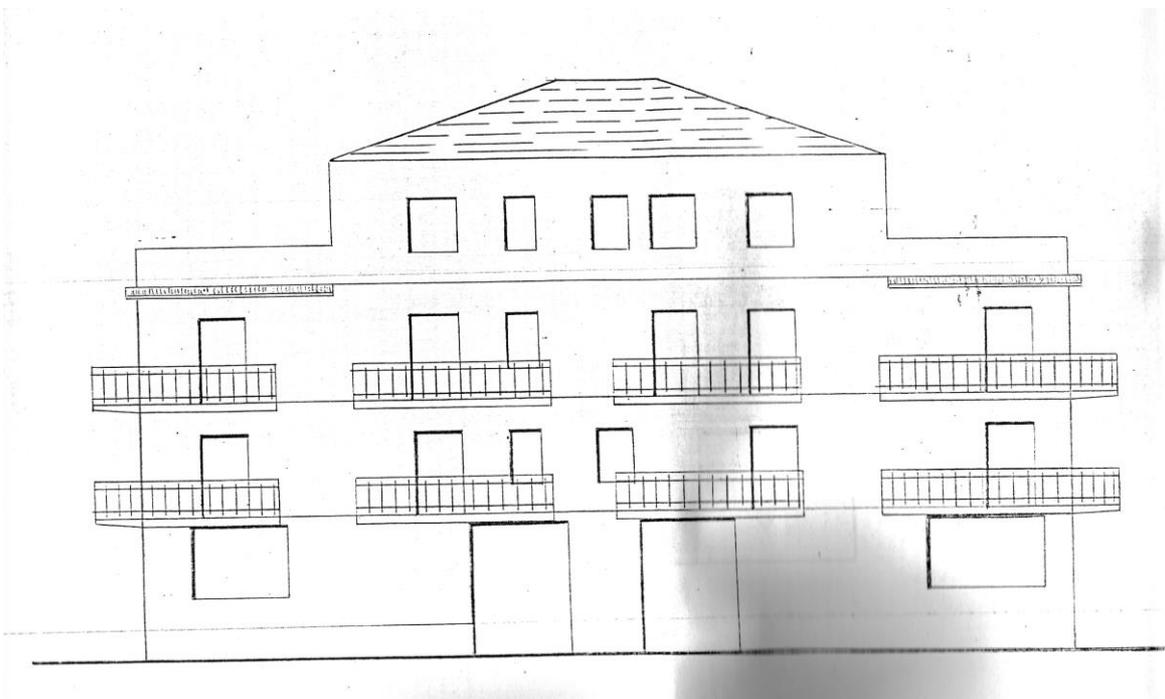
Confronto tra lo stralcio di progetto “Concessione Edilizia n. 69 del 25 agosto 1988” ed il prospetto secondario
